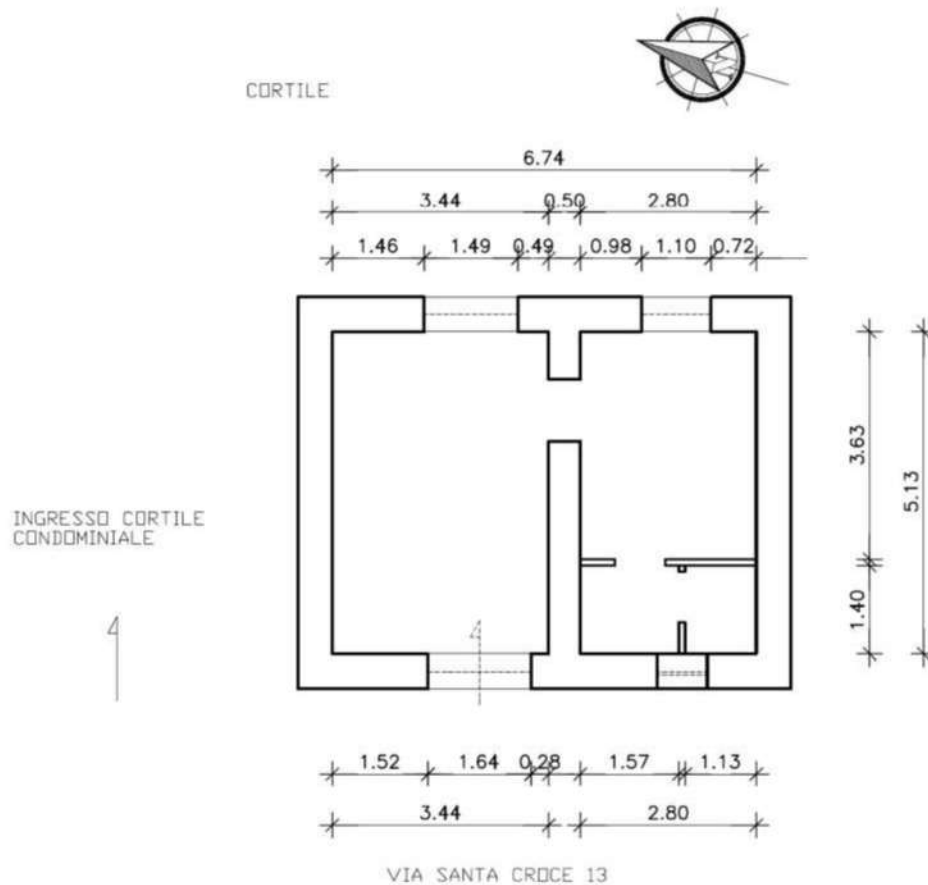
STATO DI FATTO - PIANTA IMMOBILE PIANO TERRA OGGETTO DI PIGNORAMENTO 2° ACCESSO DEL 28/03/2025
